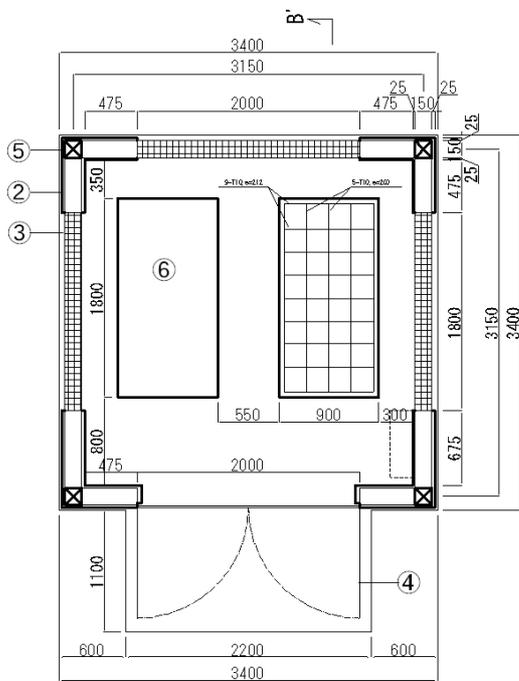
Plan structural standard de château d'eau (40 m<sup>3</sup>, H = 12 m)
